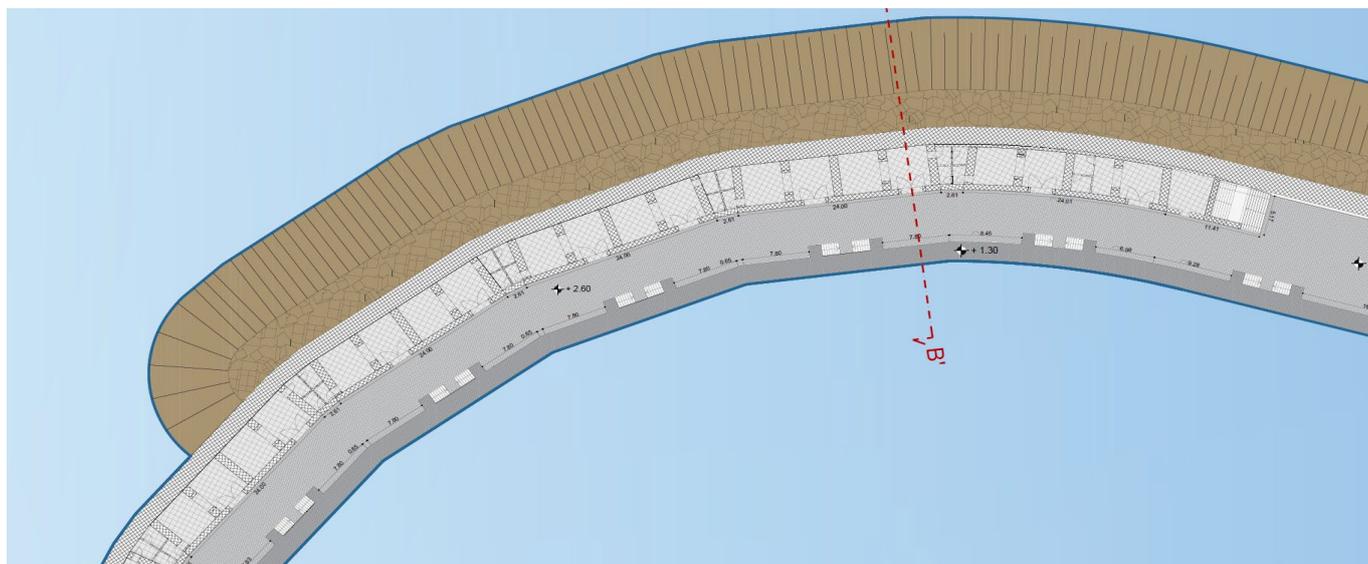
Stralcio pianta architettonica del molo sopraflutto di nuova realizzazione
